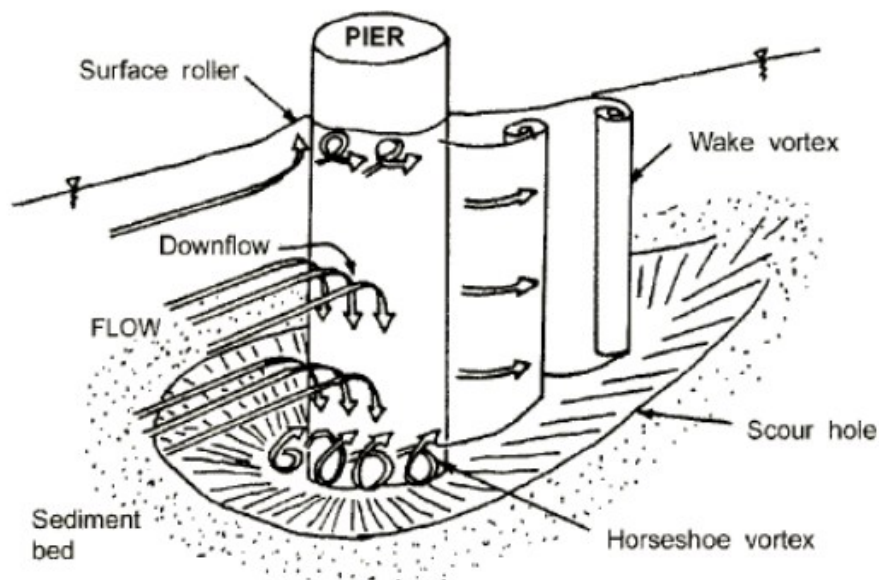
a Schema dei fenomeni locali che interessano una pila da ponte con particolare riferimento alla formazione di vortici e all'erosione alla base della pila (Melville et al.)¹⁰
